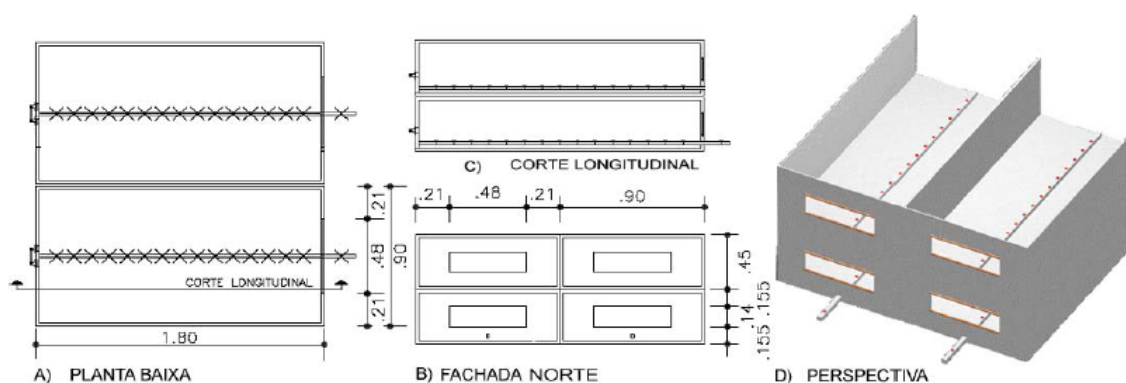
Planta, fachada norte, corte longitudinal e perspectiva dos protótipos onde os painéis LCP foram acoplados para medição das iluminâncias.
